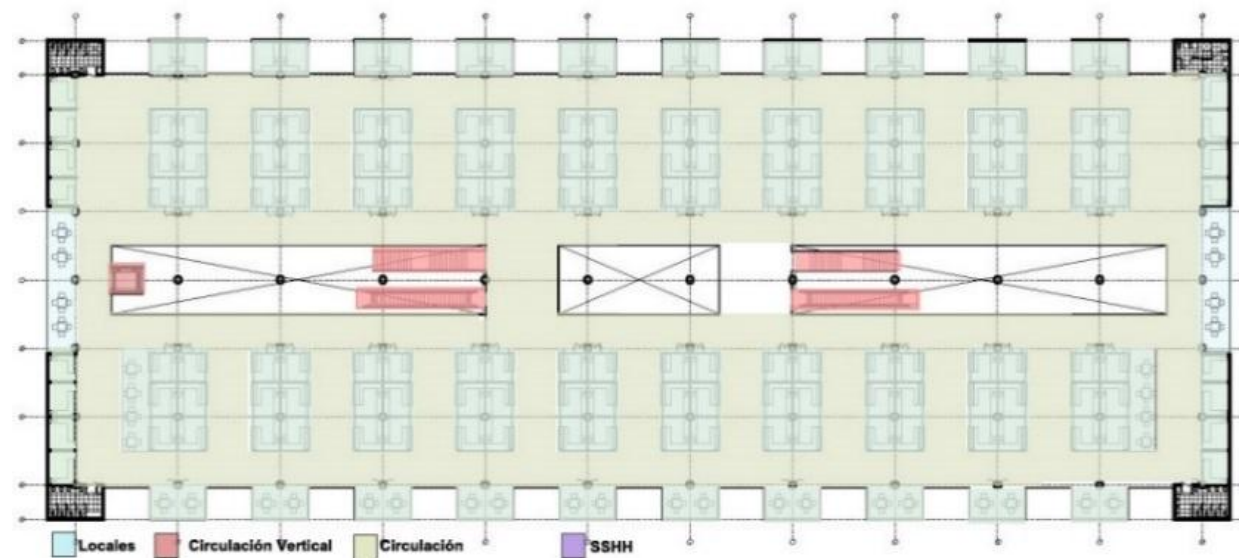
PLANTA BAJA DEL MERCADO TIRSO DE MOLINA
